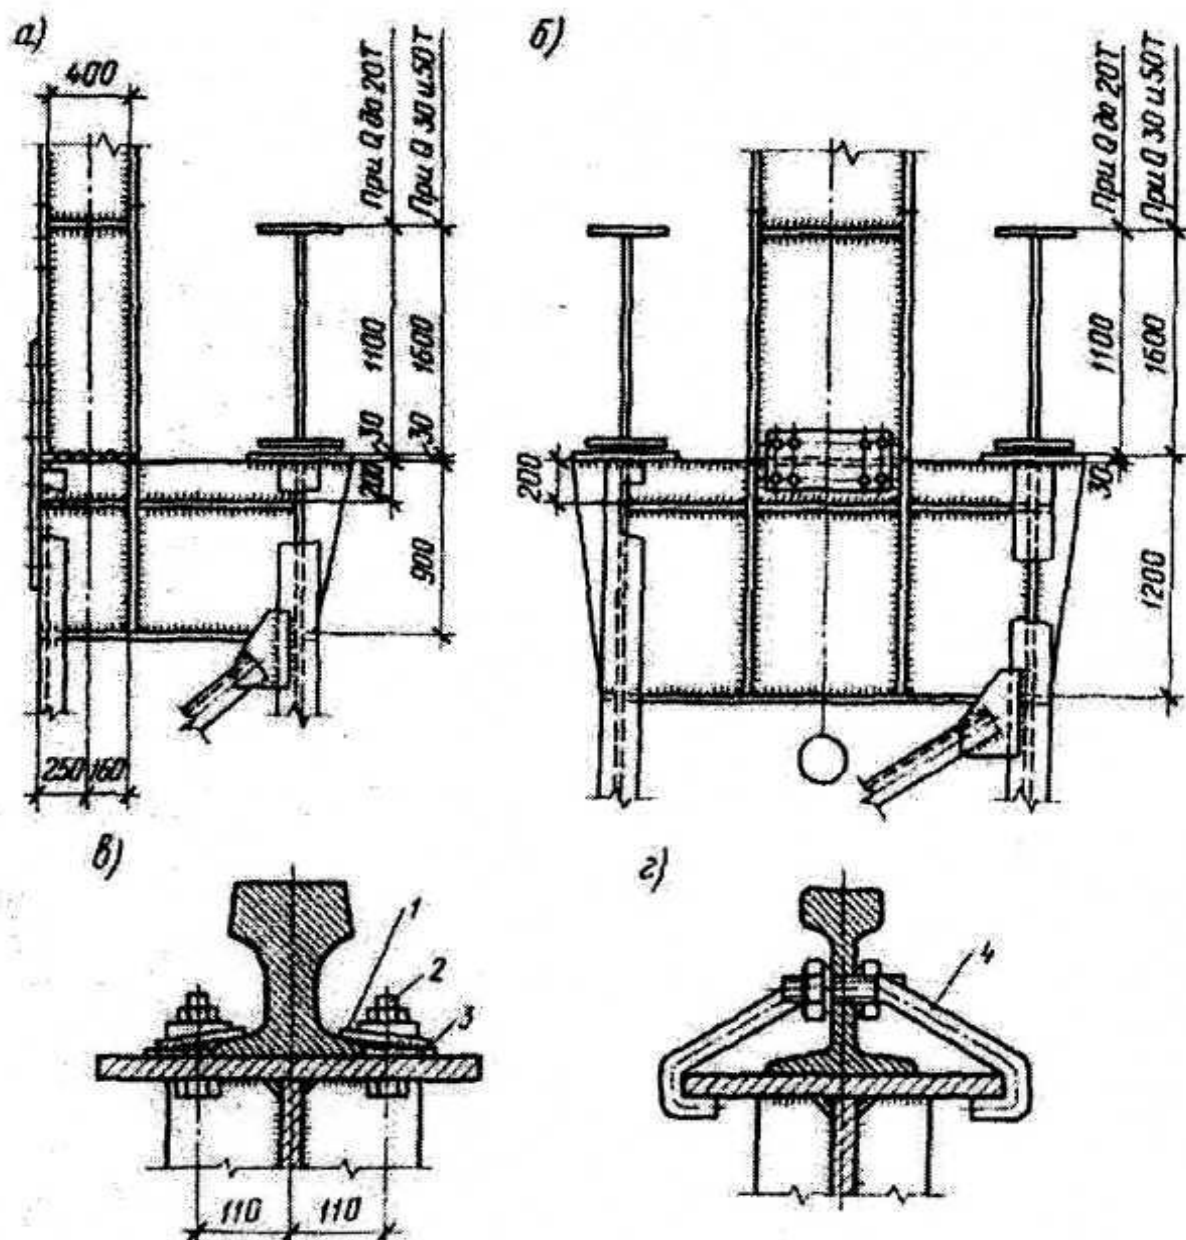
Опираие стальной бодкрановой балки: а - по колоннам крайнего ряда; б - по колоннам среднего ряда; в - крепление рельса планками; г - крепление рельса; 1 - стальная лапка; 2 - болт; 3 - упругая прокладка; 4- крюк с гайкой
